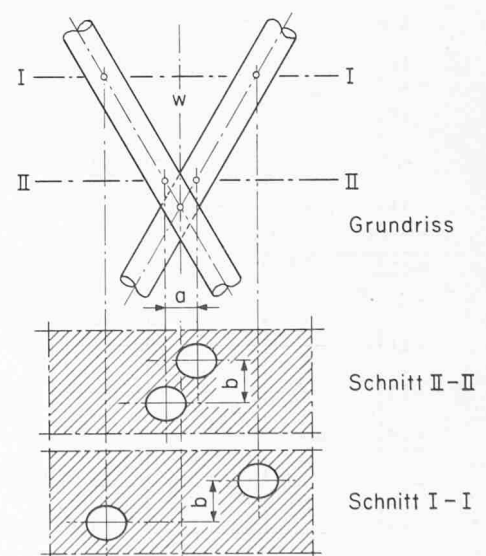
Grundriss und Schnitte bei einer Tunnelunterfahrung
